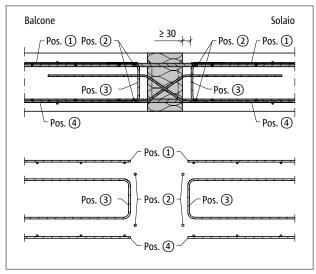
Schöck Isokorb® tipo DXT: armatura in opera
